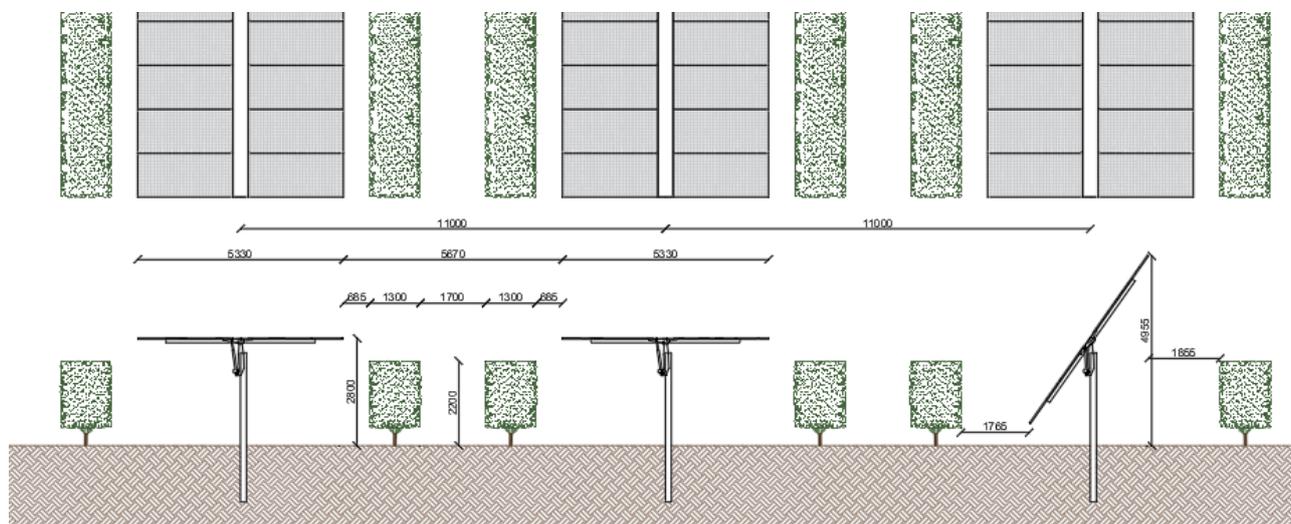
Sezione tipo dell'assetto agrovoltaico
